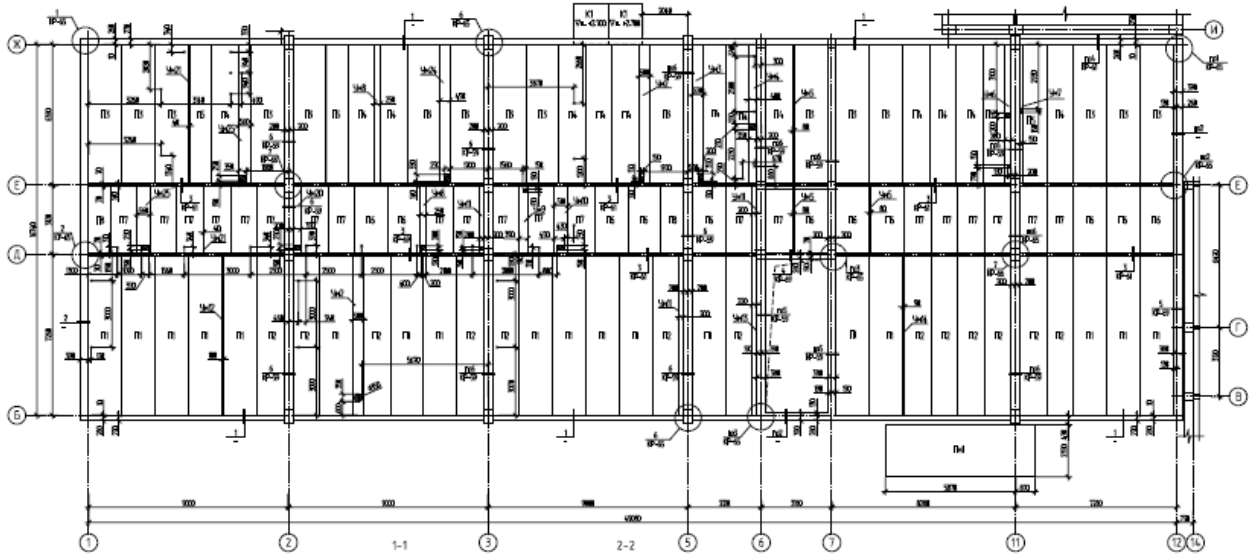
Схема расположения плит перекрытия и антисейсмического пояса на отм. + 3,000 в осях Б-Ж, 1-12
